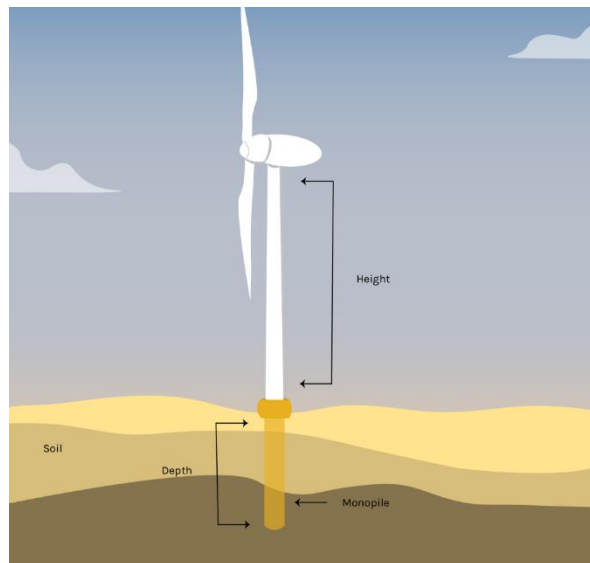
6. Éoliennes terrestres avec une fondation type pieu
